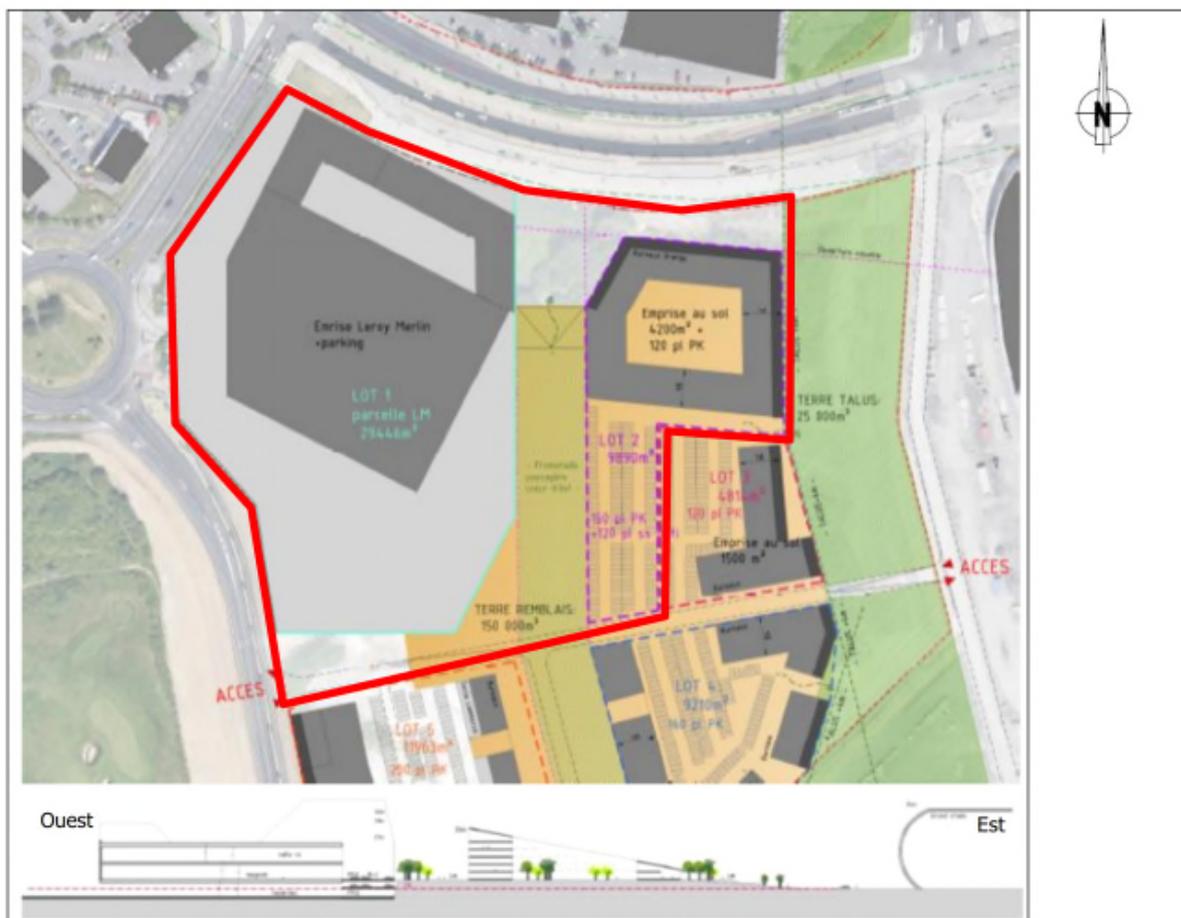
schéma du plan de masse + coupe du projet (source : AvantPropos Architectes)
